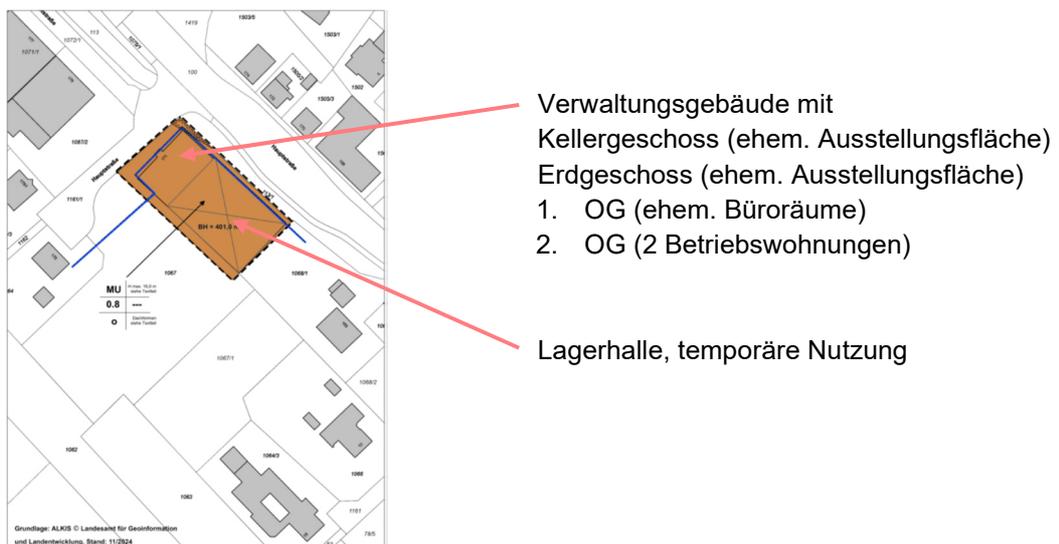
Auszug Bebauungsplan mit Abgrenzung Geltungsbereich Plangrundlage Gemeindeverwaltung Kuchen
